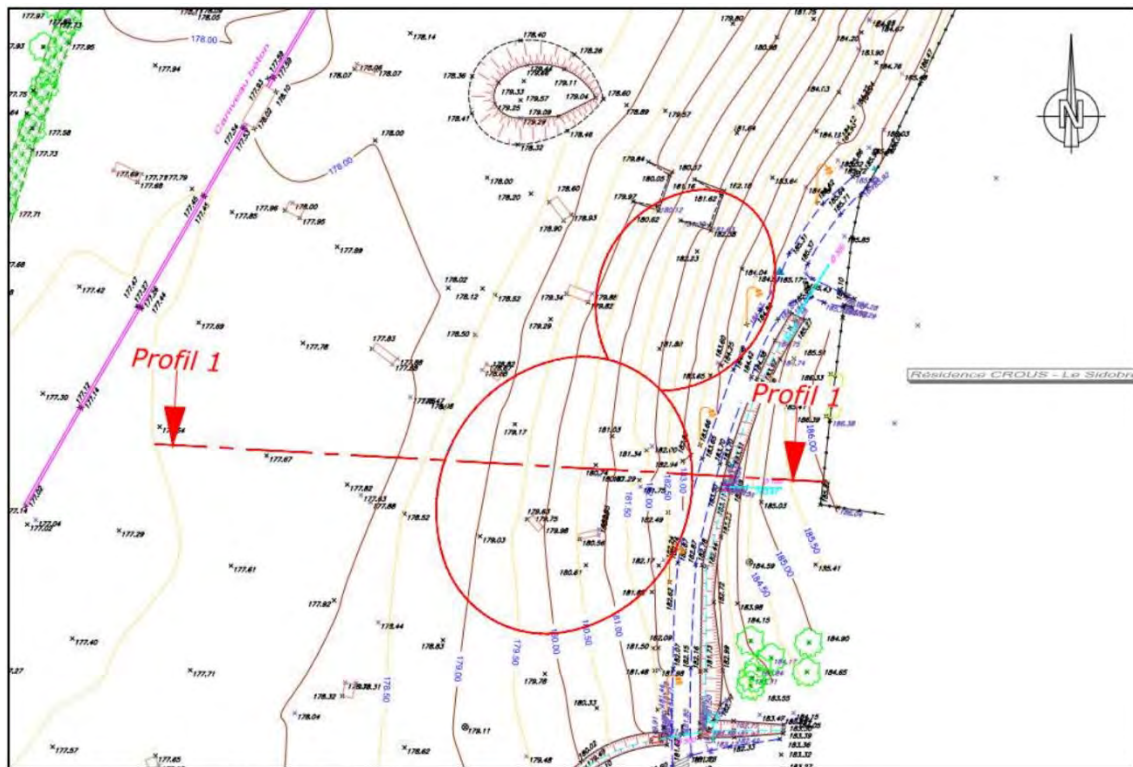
Implantation du profil 1 sur fond de plan topographique
